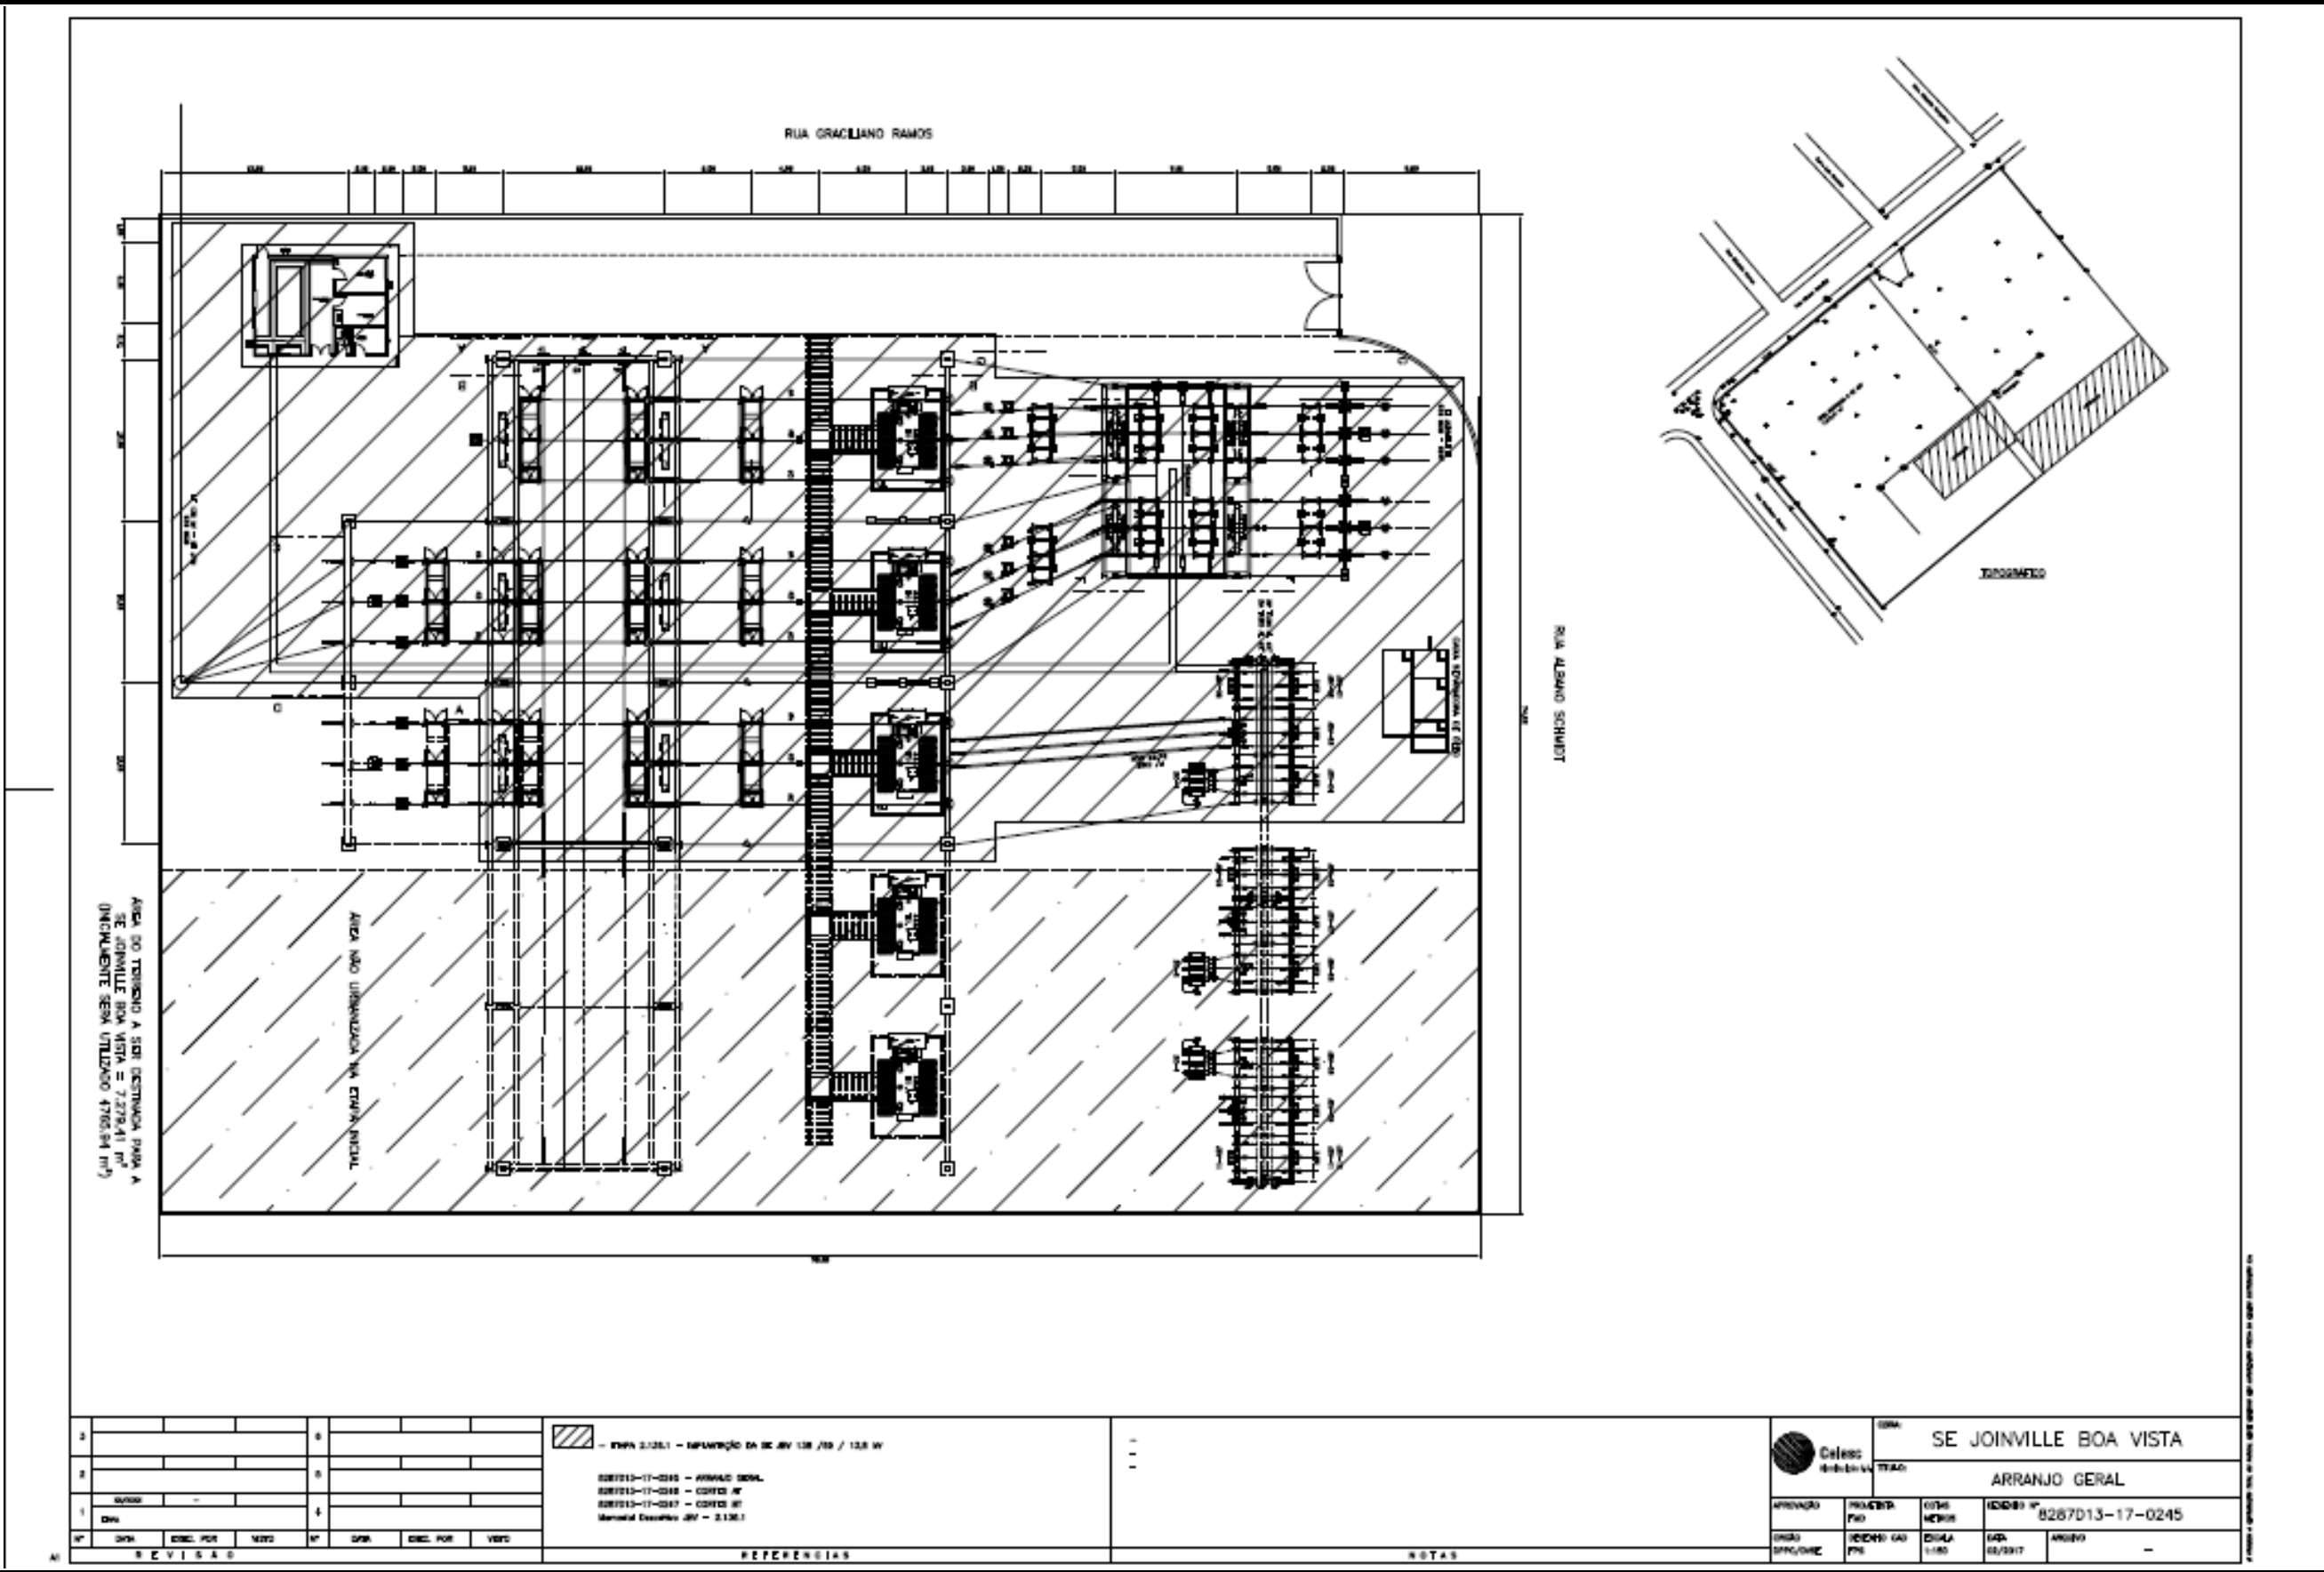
Arranjo Geral da Subestação Elétrica Joinville - Boa Vista
